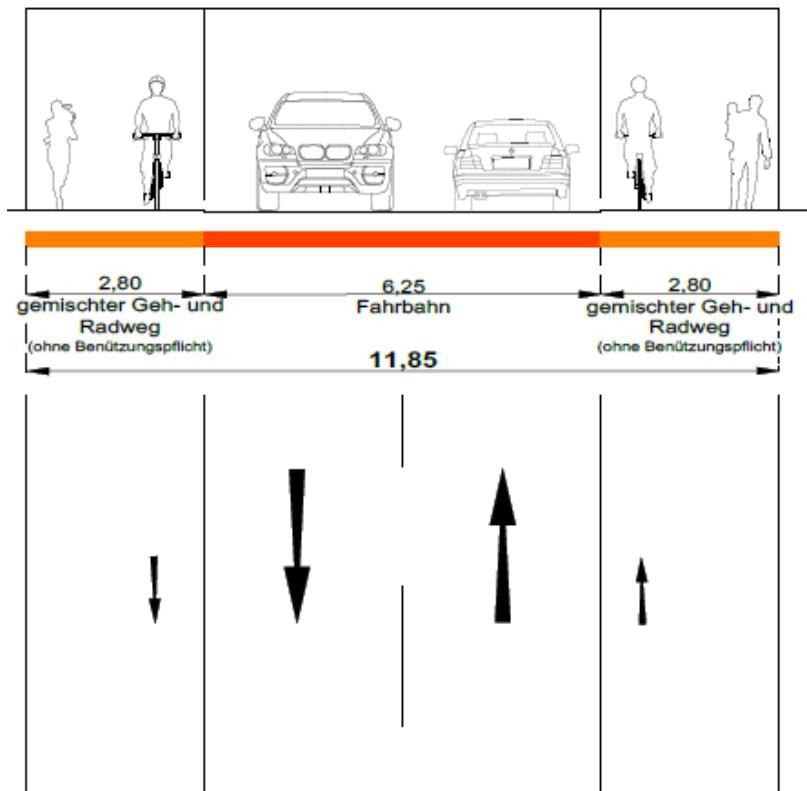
Querschnitt Planfall 2, [Quelle: PLANUM]
